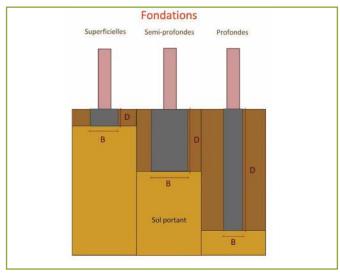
Schéma en coupe des différents types de fondation (Dessin de Cédric Houel)
